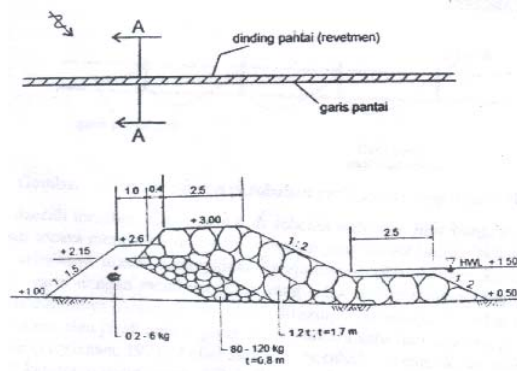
Beberapa Tipe Bangunan Pelindung Pantai
